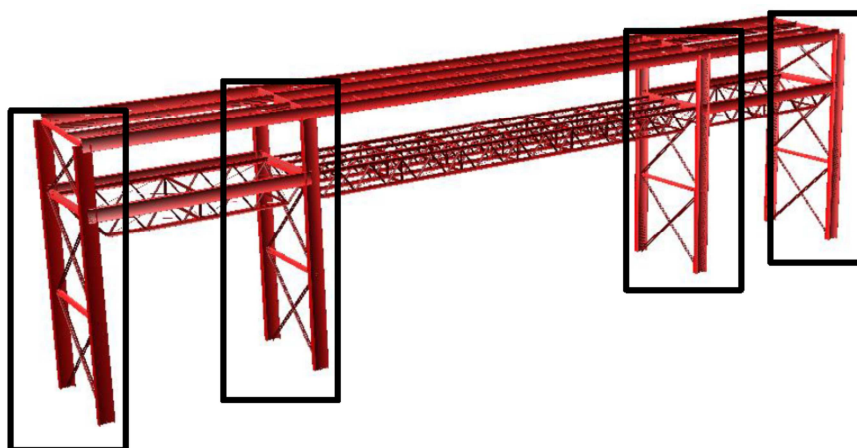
Sistema de contraventamento adotados para redução das acelerações transversais.
